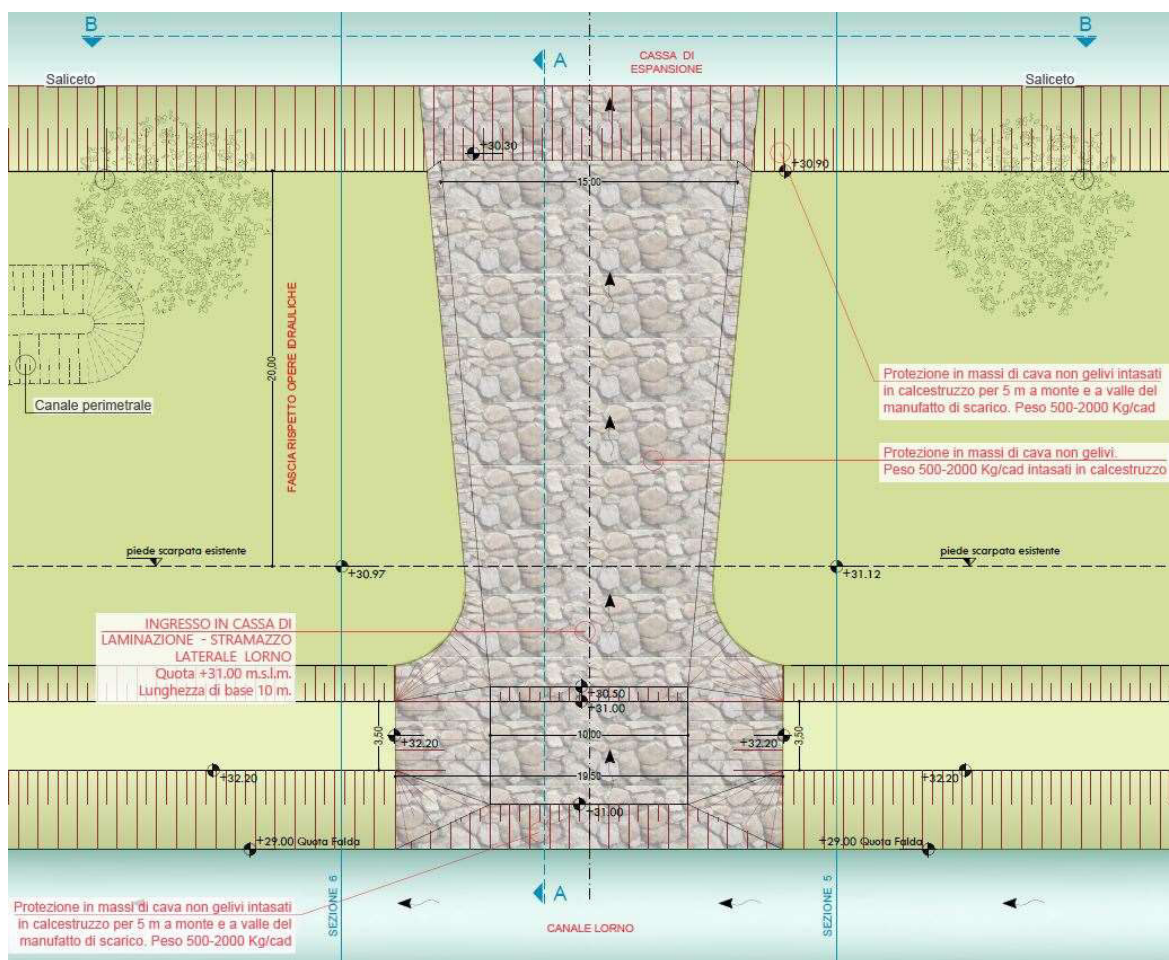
Manufatto di ingresso canale Lorno: planimetria.
